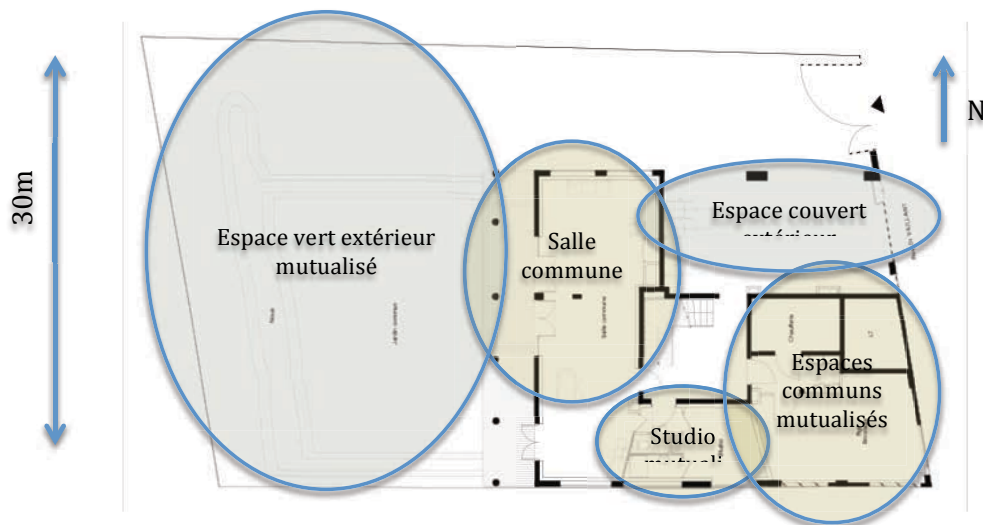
plan RdC, opération « la Salière », surfaces extérieures et annexes : atelier et préau. Plan TEKNHE.
